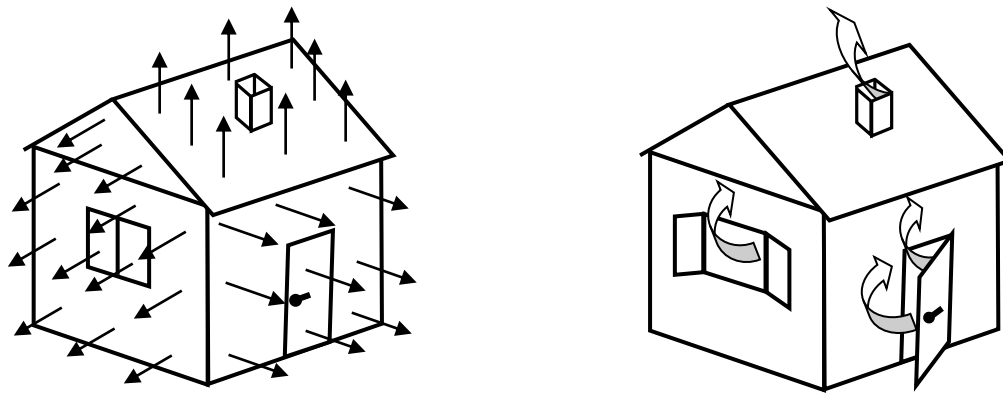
Теплові втрати в навколишнє середовище крізь огорожувальні конструкції та вентиляцію.
